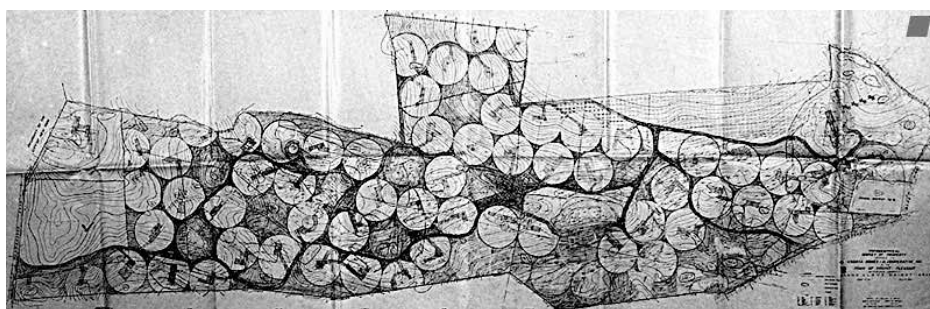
Sol Friedman House, Toy Hill_ Planta de implantação (Wright 1948)
